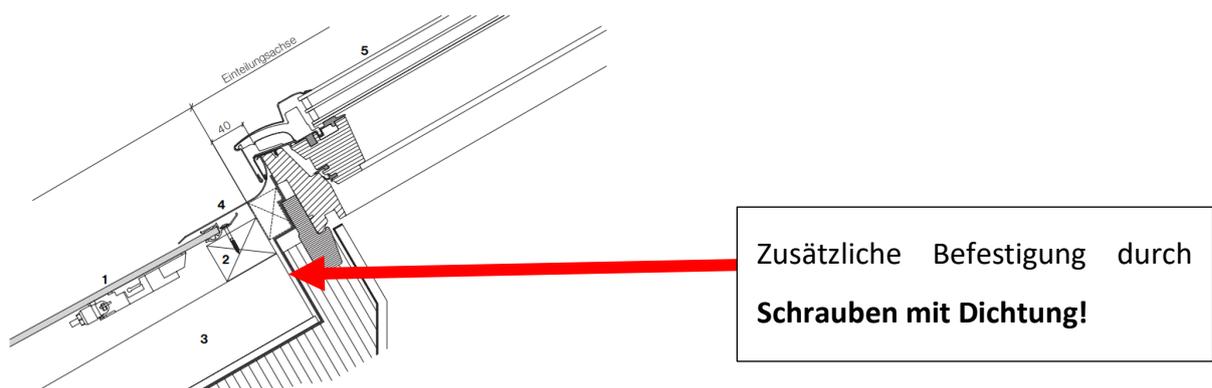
Anschluss unten (Quelle: Swisspearl Details Sunskin Roof Lap)
